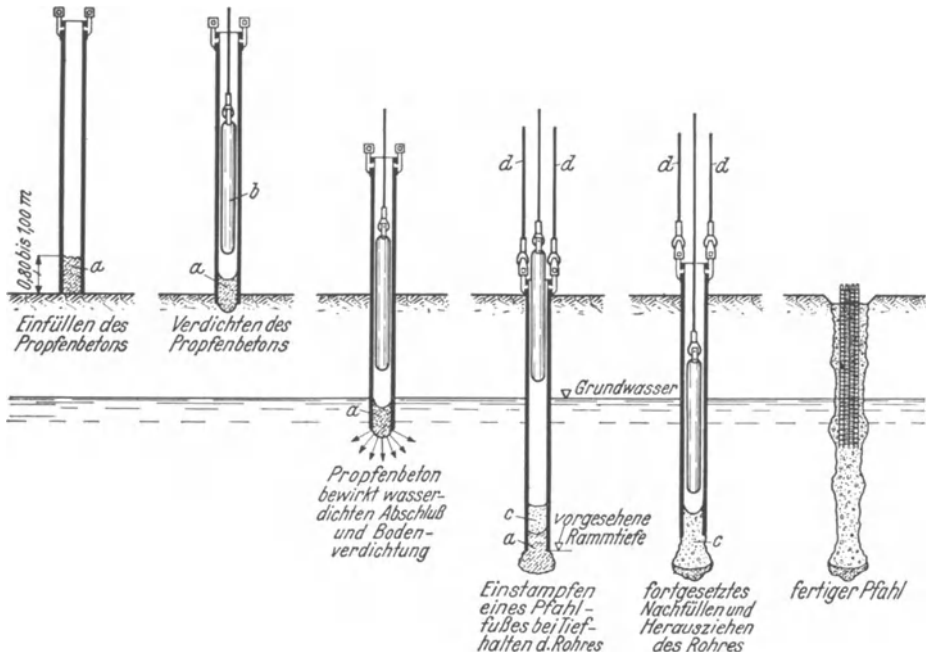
Herstellung des Franki-Pfahls durch Einrammen eines Eisenrohrs, das unten mit einem Betonpropfen verschlossen ist und dann unter Einfüllen von Beton gezogen wird.
